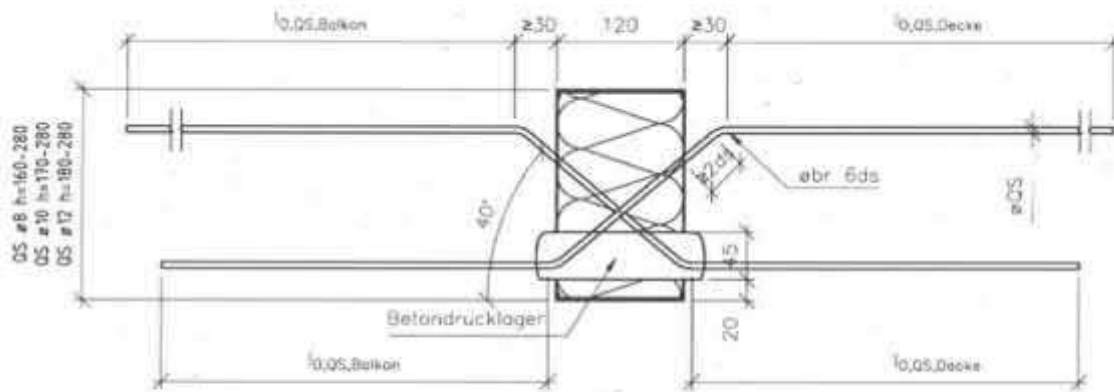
Elementschnitt ISOPRO® 120 – QQ/QQS, Stabdurchmesser 8, 10, 12 – deckenseitig gerade Ausführung ISOPRO® 80 mit Stabneigung 45°
